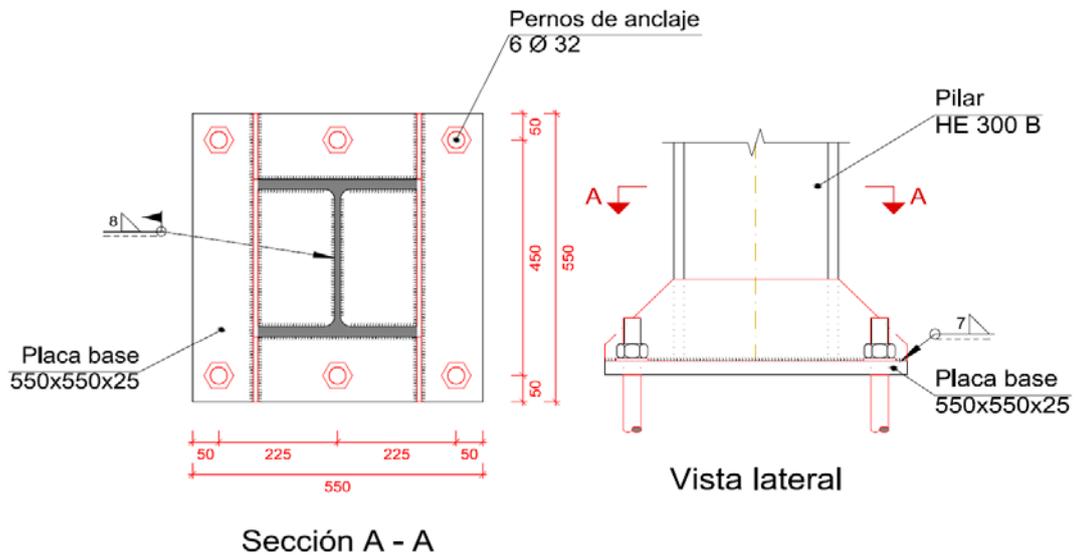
Placa de anclaje tipo 11 (fachada frontal).
